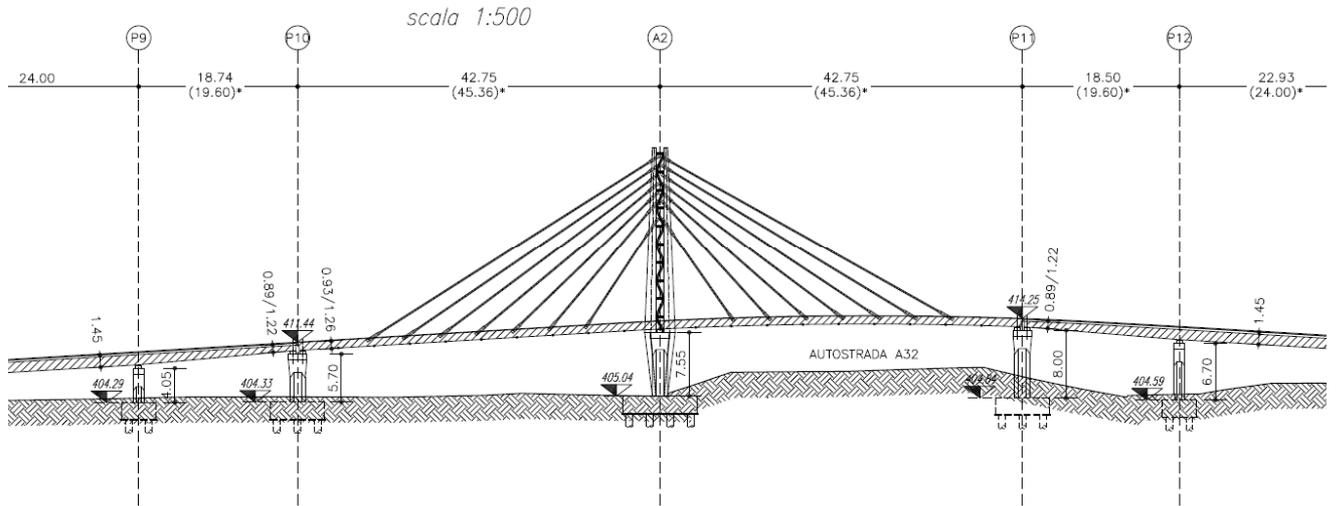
Stralcio del profilo dello svincolo - Sovrappasso in ingresso
